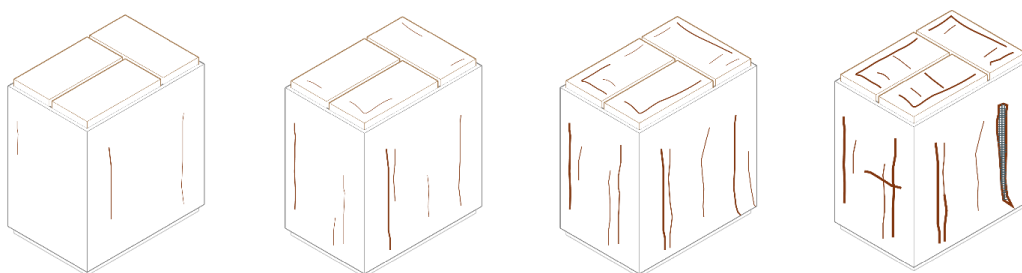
schema del quadro fessurativo previsto in prospetto per colonne a base rettangolare (RT FRCM)
